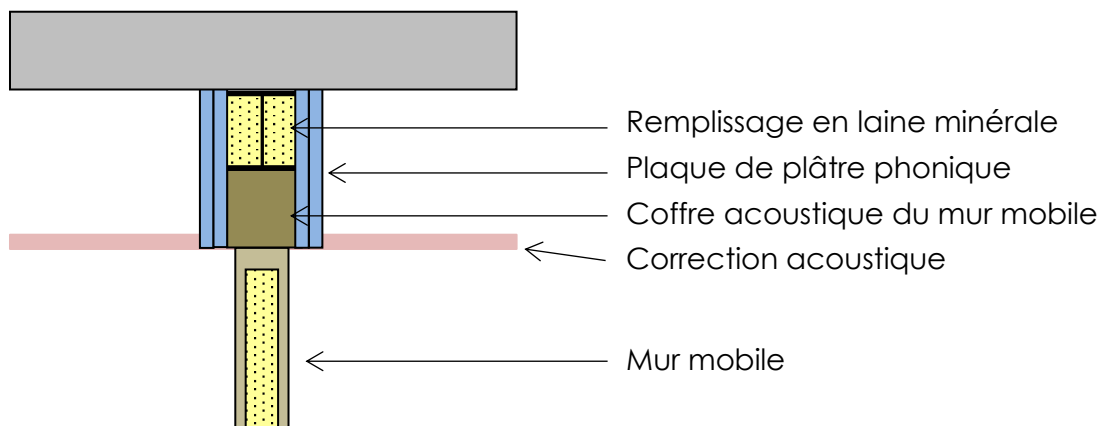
Schéma de principe – Jonction murs mobile avec le portique et la sous face de toiture béton (Coupe)
